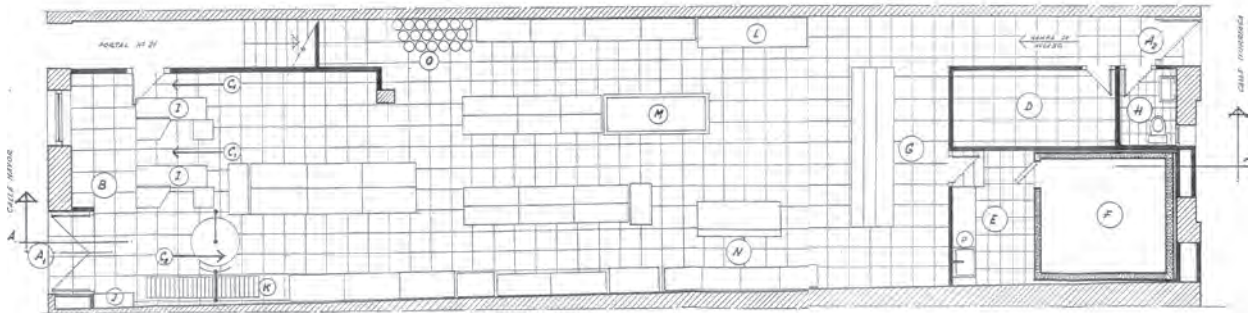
14. 1988 PLANTA DE LOCAL COMERCIAL EN PLANTA BAJA
